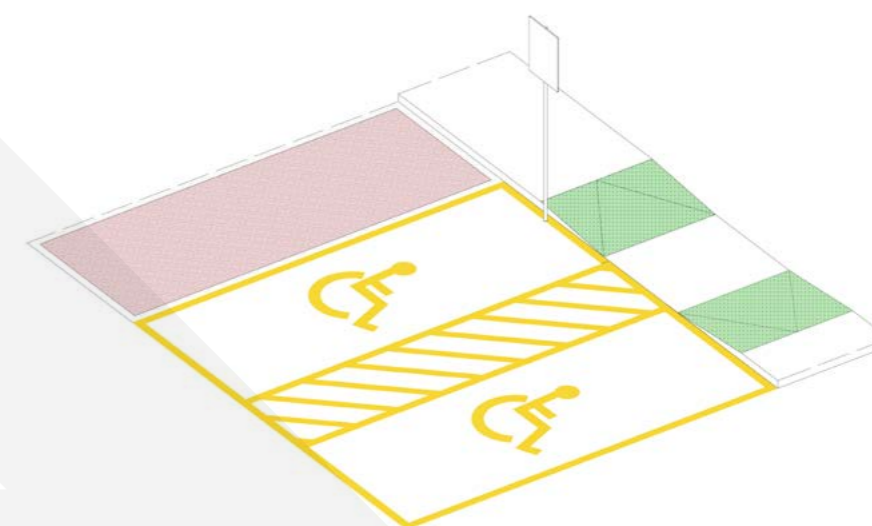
Schema di posti auto caratterizzati da pavimentazione non accessibile
